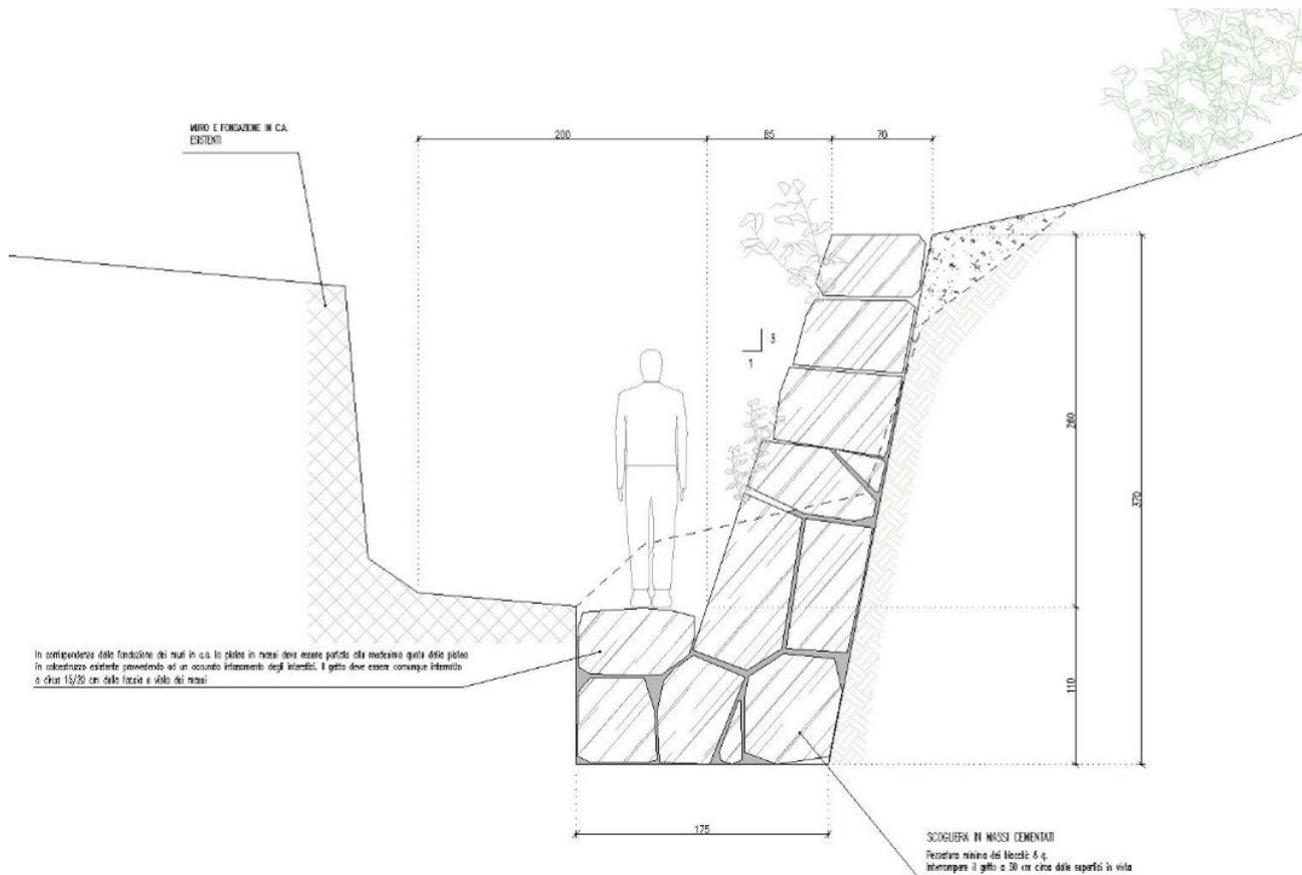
Profilo lavoro di stabilizzazione con rivestimento in massi da scogliera
